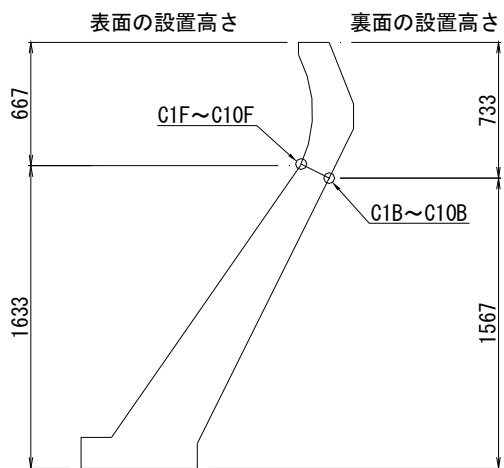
側面から見たひずみゲージ位置 (単位: mm)
